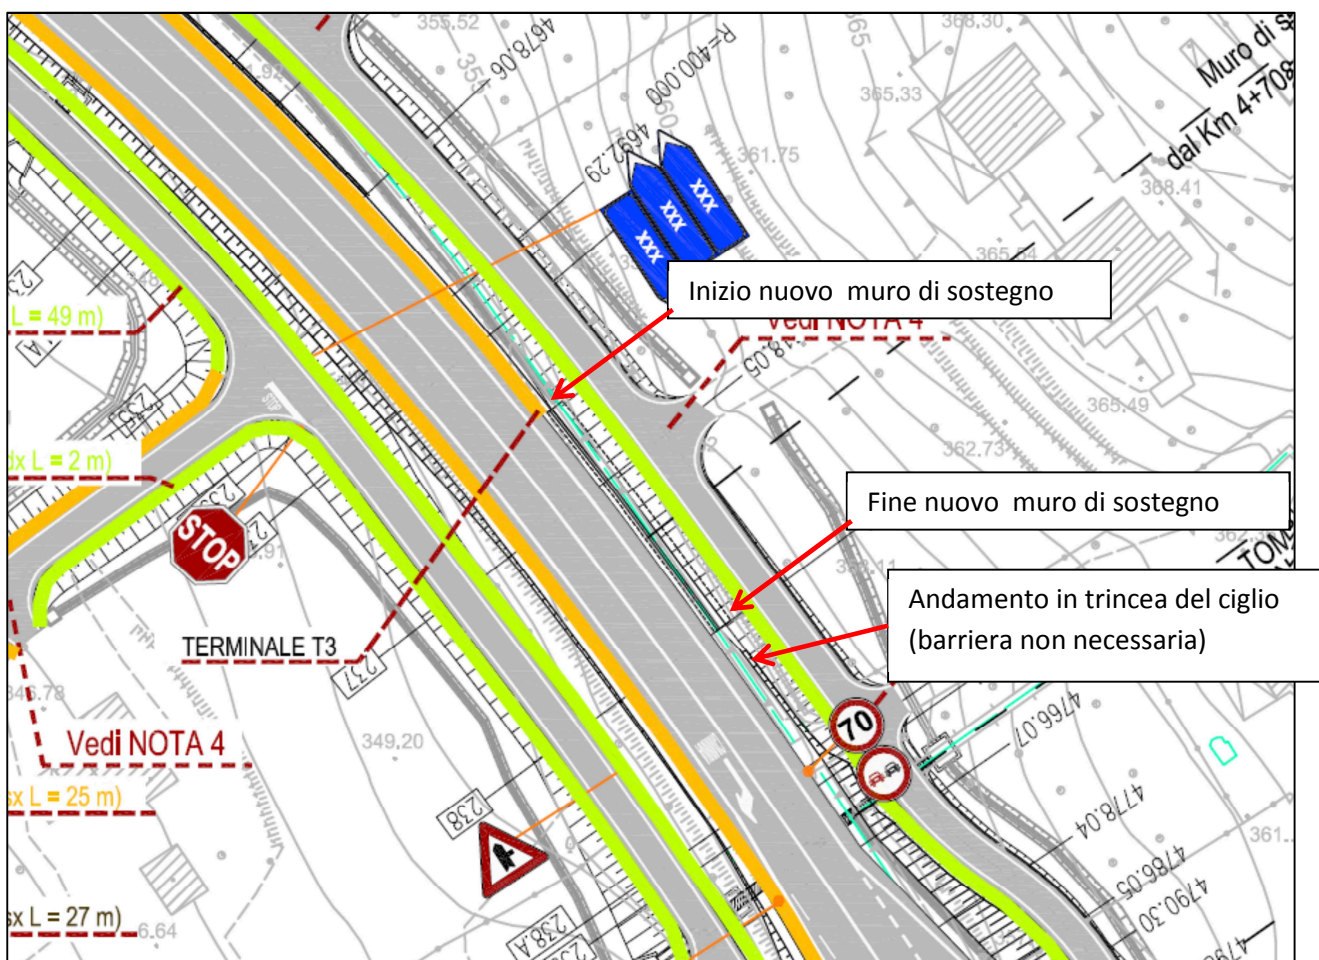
Stralcio planimetrico planimetria barriere di sicurezza di PED
